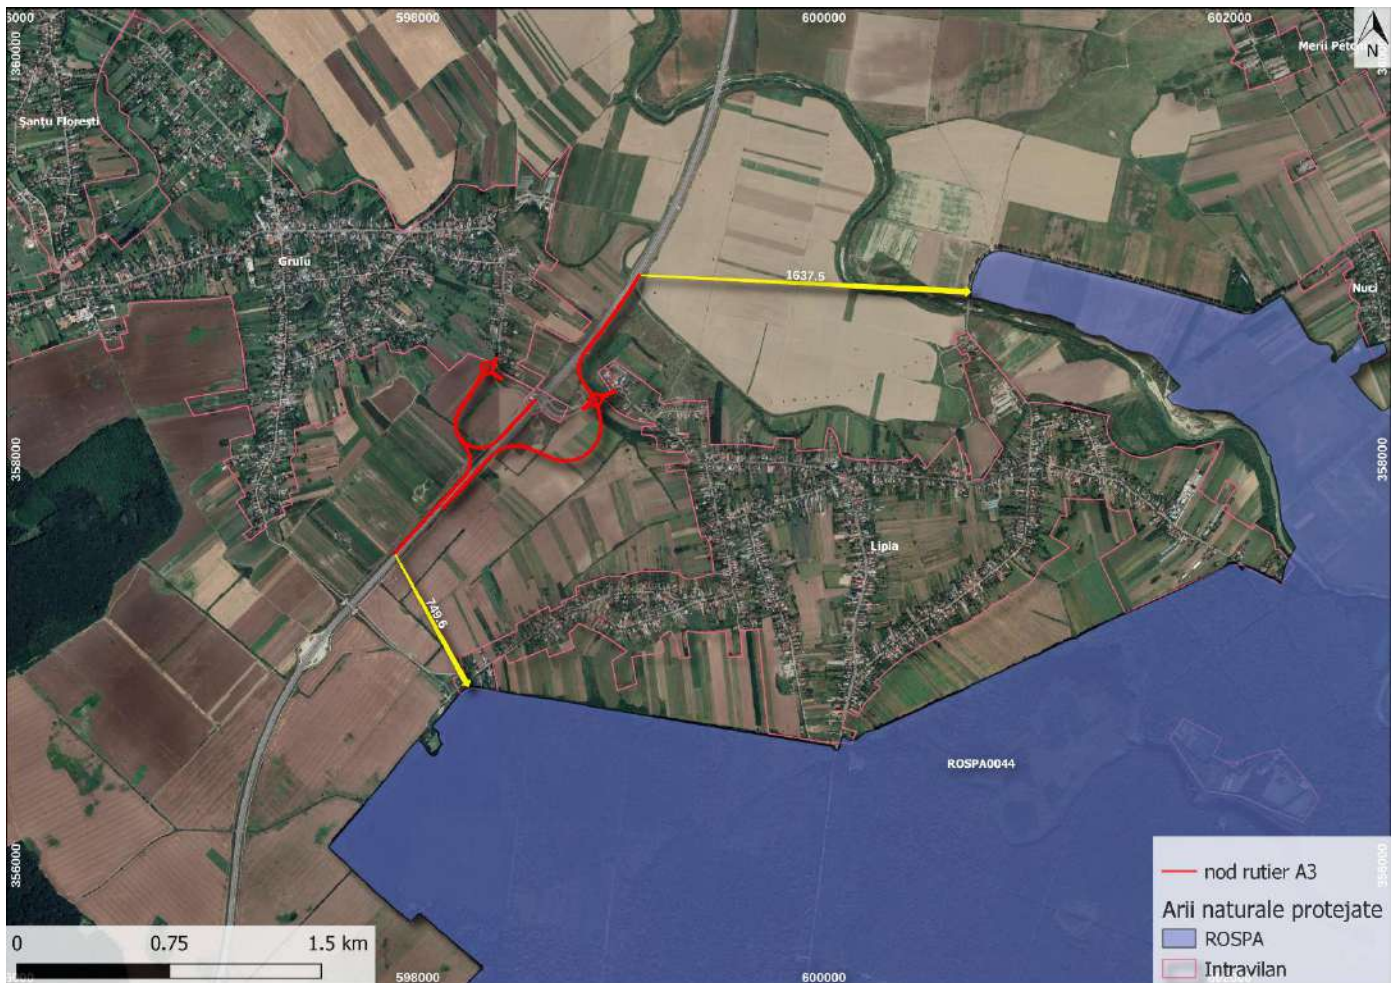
Plan de încadrare în zonă – Distanța până la aria protejată
